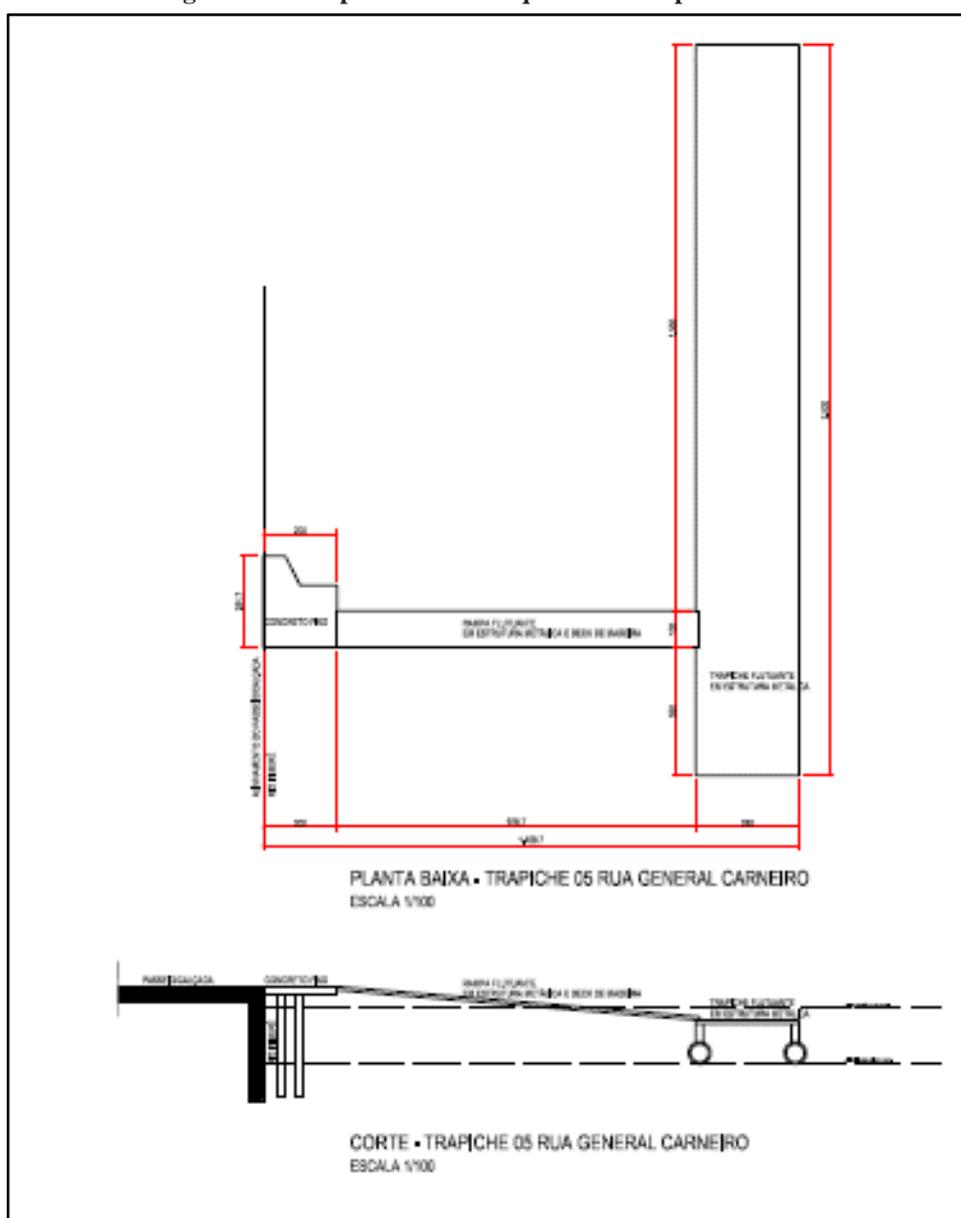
Trapiche de embarque para lanchas (táxi náutico) – Planta baixa e corte
